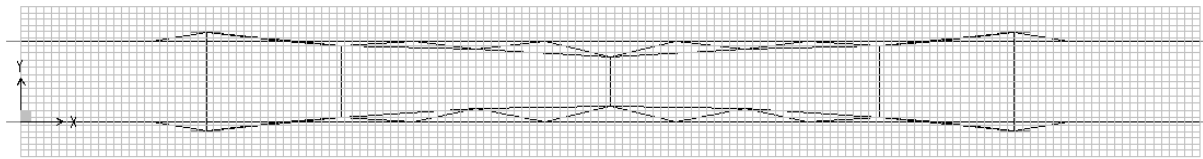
Visualização em planta da estrutura em SAP2000
